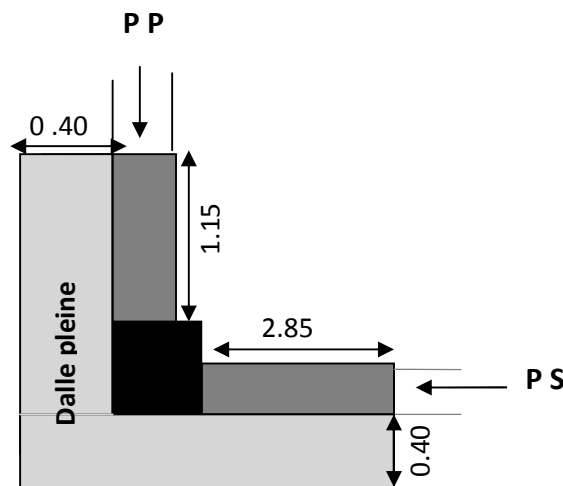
c : Surface revenant au Poteau central B-3(Terrasse couvrant le Bâtiment)
